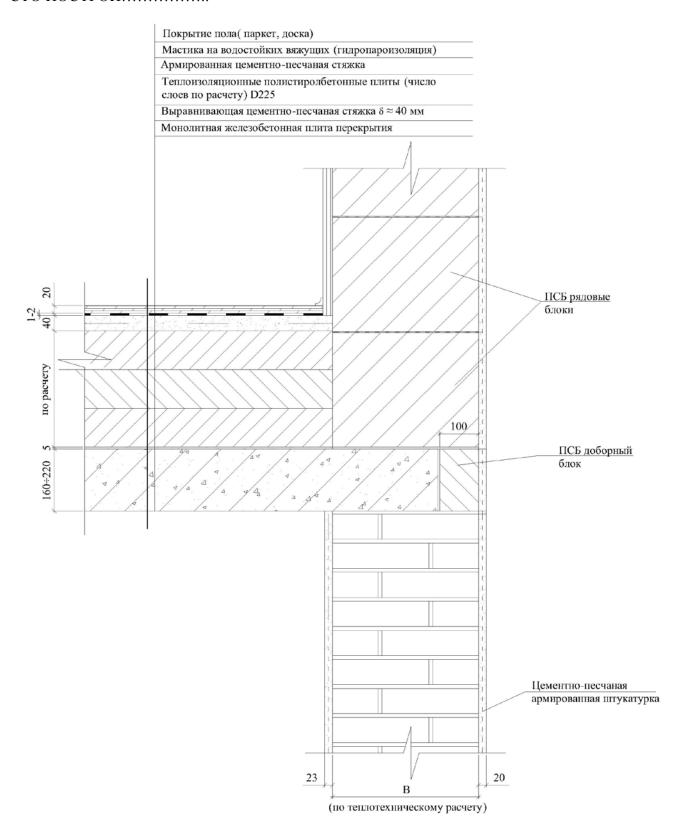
Утепление перекрытия над холодными подвалами (подпольями, проездами) с использованием теплоизоляционных плит из полистиролбетона
